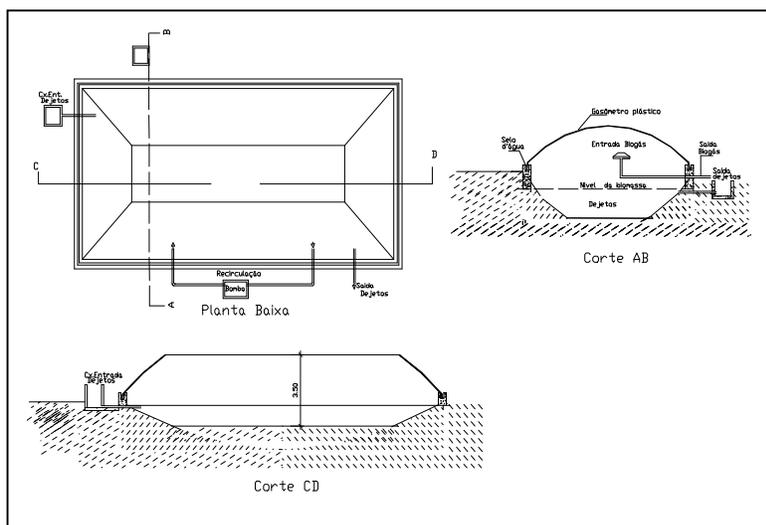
Planta e Corte esquemático do biodigestor revestido e coberto com vinimanta de PVC.
